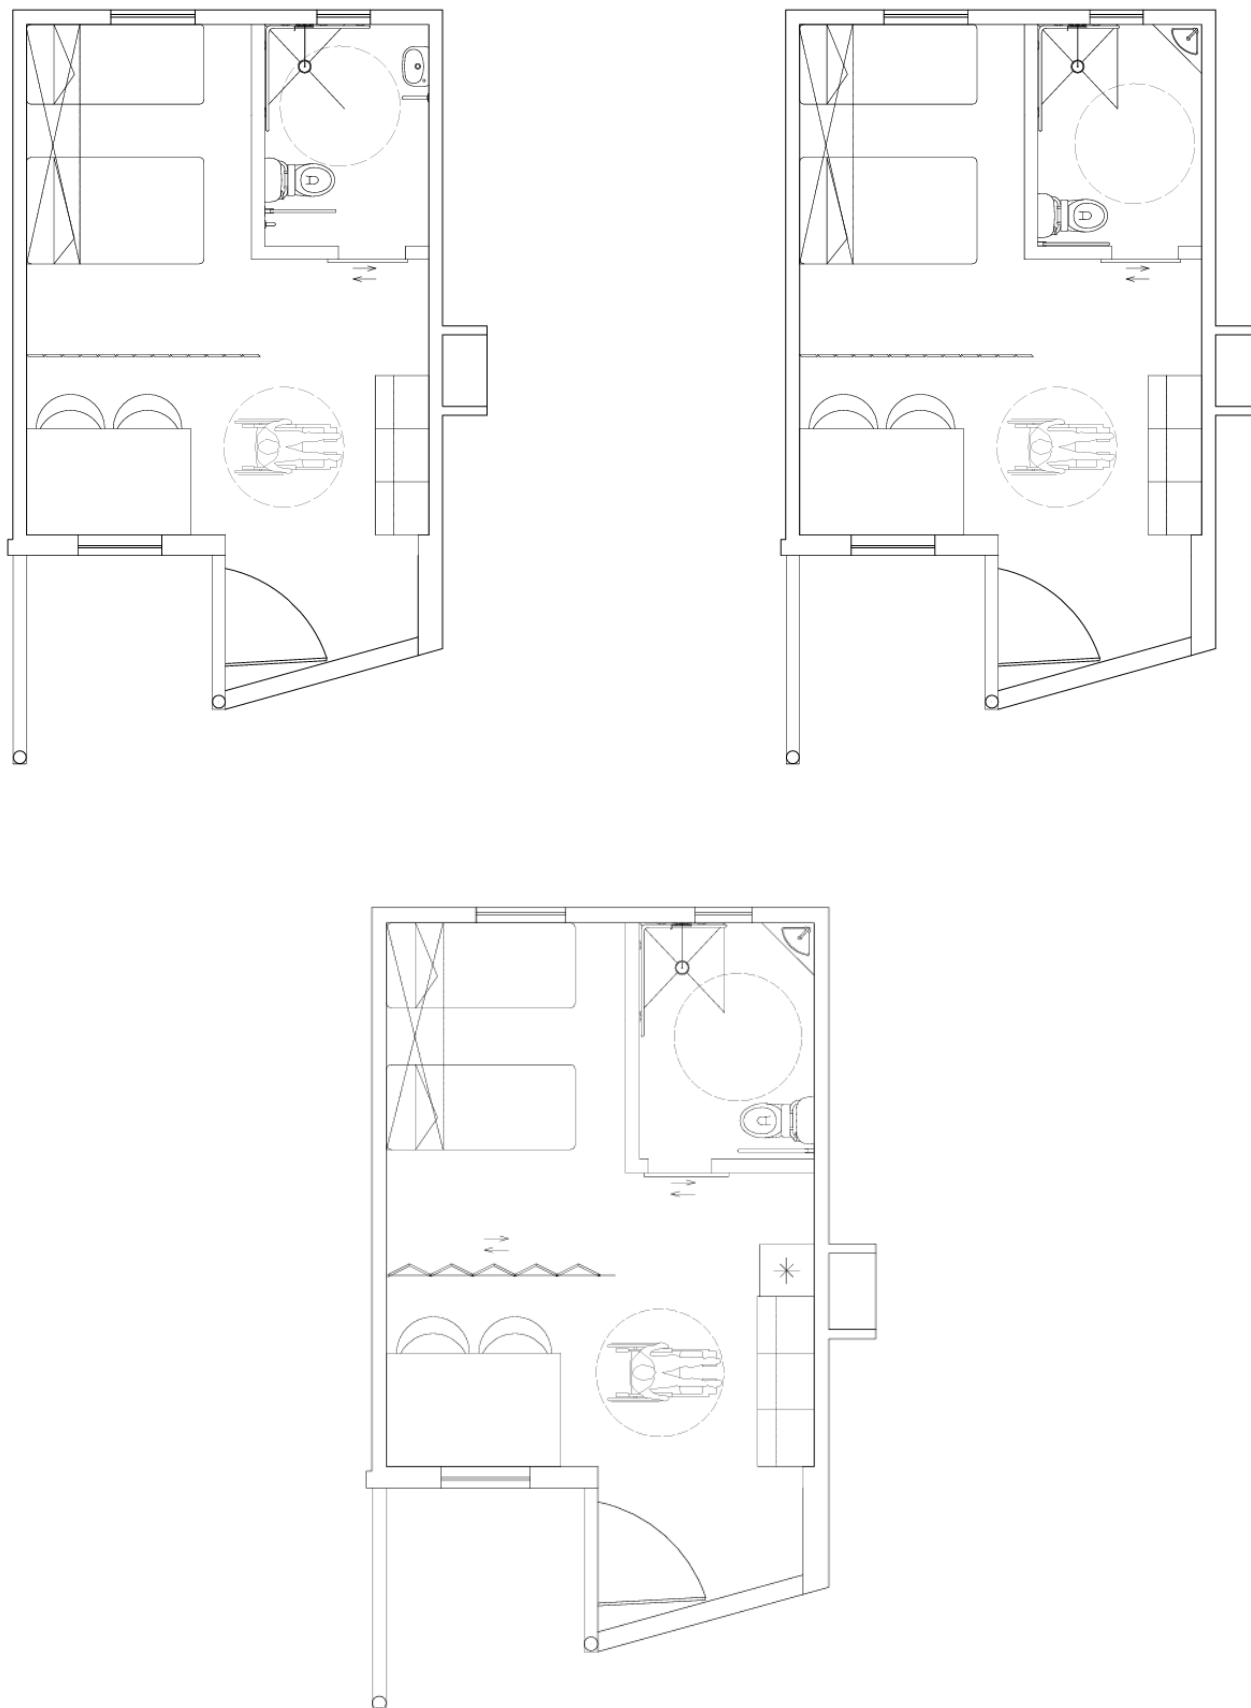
, 38 e 39 (respetivamente) – Plantas de estudo - Bungalow 1 (Fonte: autora)
